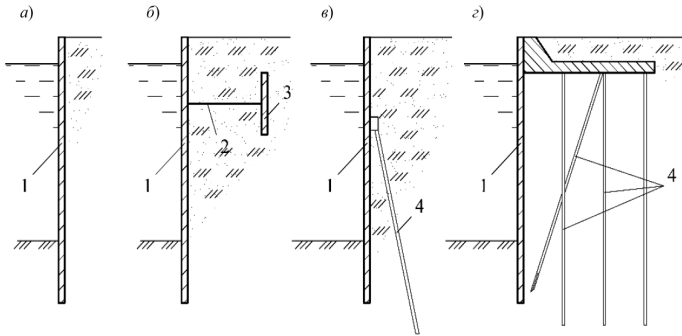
Шпунтовые и свайные подпорные стены:
